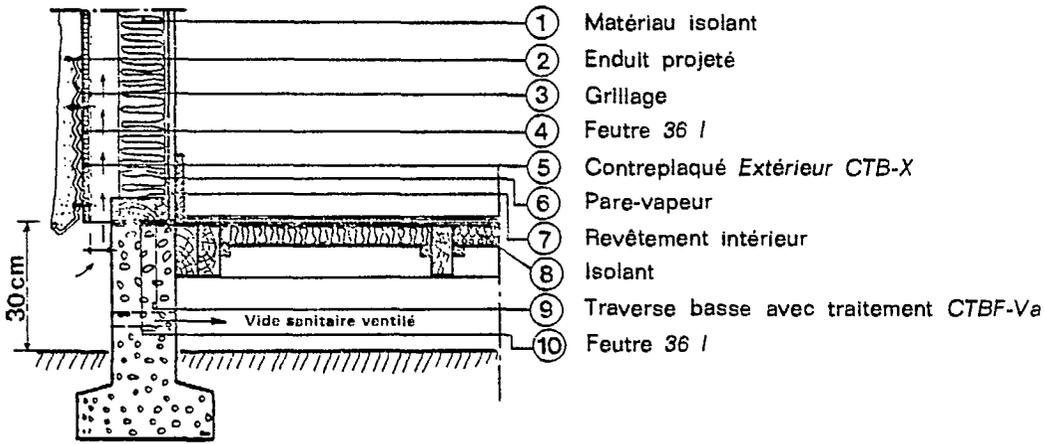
Mur ventilé avec revêtement extérieur en enduit hydraulique projeté sur armature ; le voile travaillant est placé sur le côté extérieur du mur. Un feutre asphalté perméable seulement à la vapeur d'eau permet de désolidariser le contreplaqué et l'enduit de son armature grillagée.
